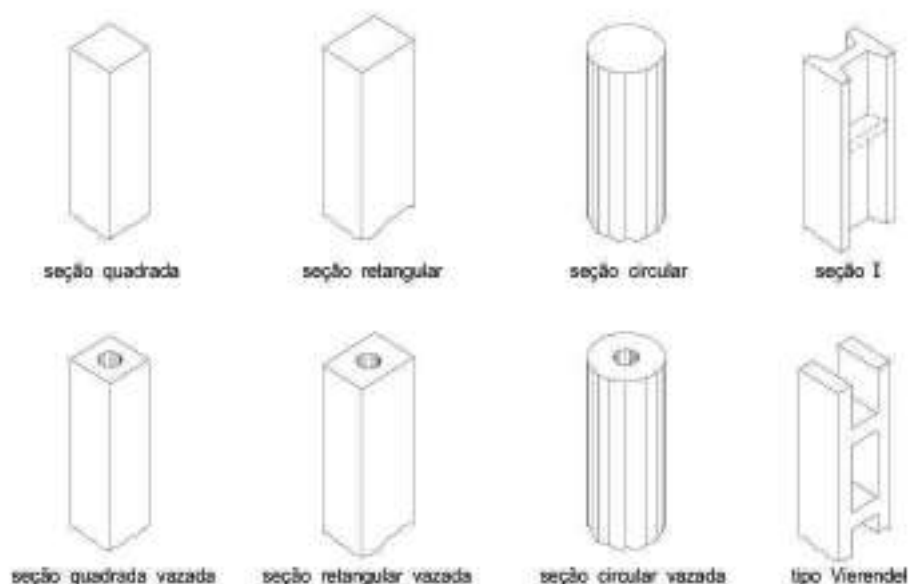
Seções transversais utilizadas em pilares pré-moldados (Fonte: El Debs,2000)
